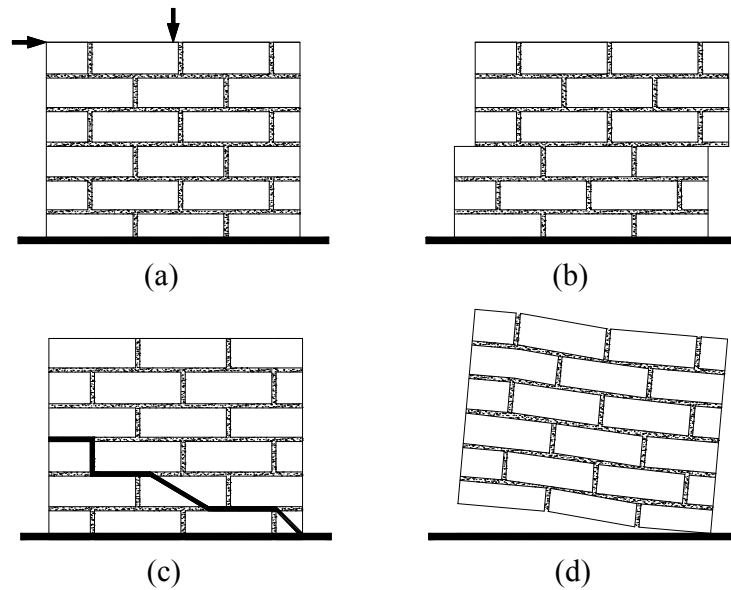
Mecanismos de rotura em paredes de alvenaria quando solicitadas no seu plano por cargas horizontais e verticais [Hamid et al., 1994]: (a) parede sob carregamento vertical e lateral; (b) rotura por corte da argamassa nas juntas; (c) a parede funciona monoliticamente exibindo deformabilidade de corte até que os mecanismos internos de tracção, associados ao funcionamento por resistência ao corte da parede, rompem; (d) rotação e esmagamento localizado.
